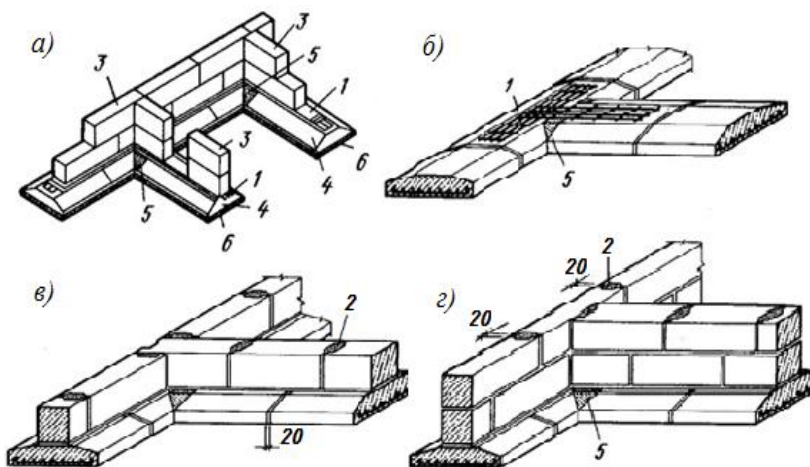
З'єднання фундаментів поздовжніх та поперечних стін:
